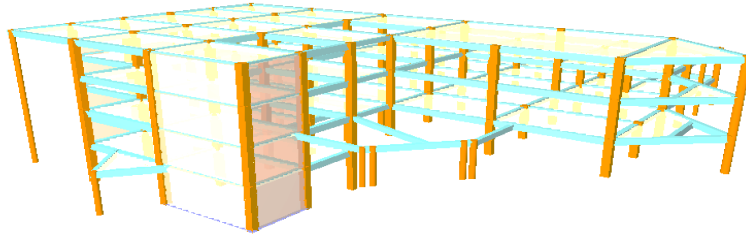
Modelamiento tridimensional 2 (Sugiriendo muros de hormigón)
